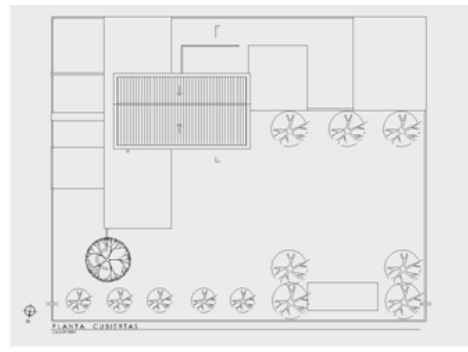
Planta de cubiertas redibujada. Fuente: Elaboración propia.
